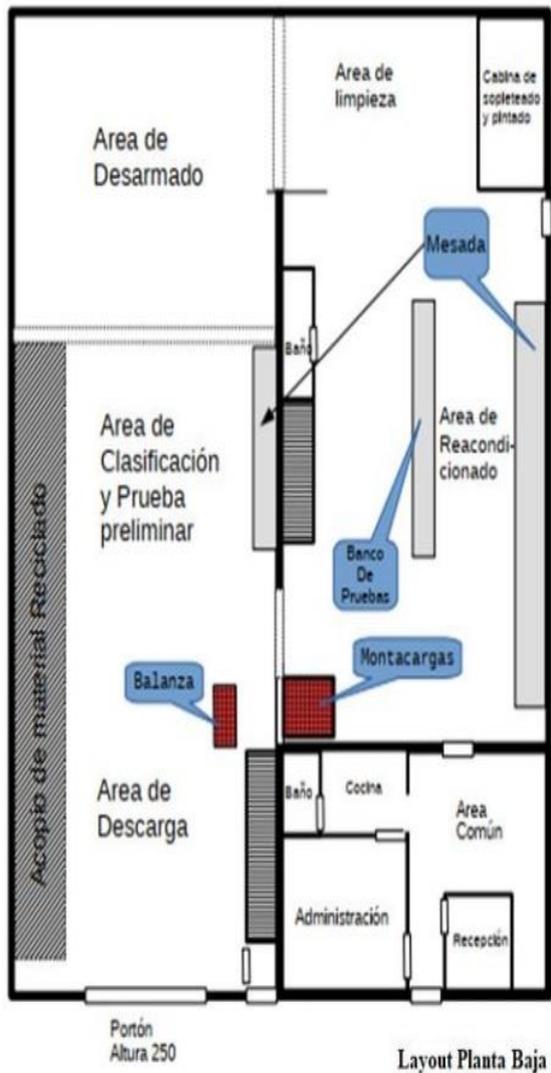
Planta baja actual de la planta de tratamiento de RAEE. Fuente: Propia.
